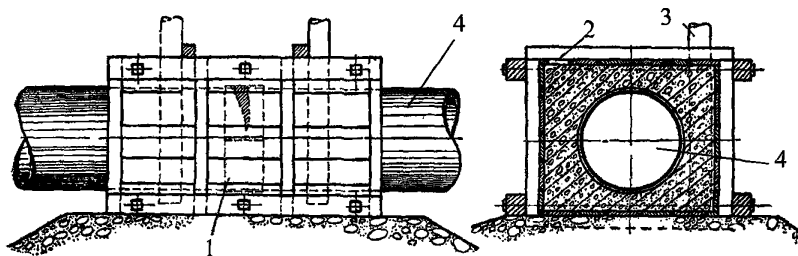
Постановка бетонного массива на трубопровод:
